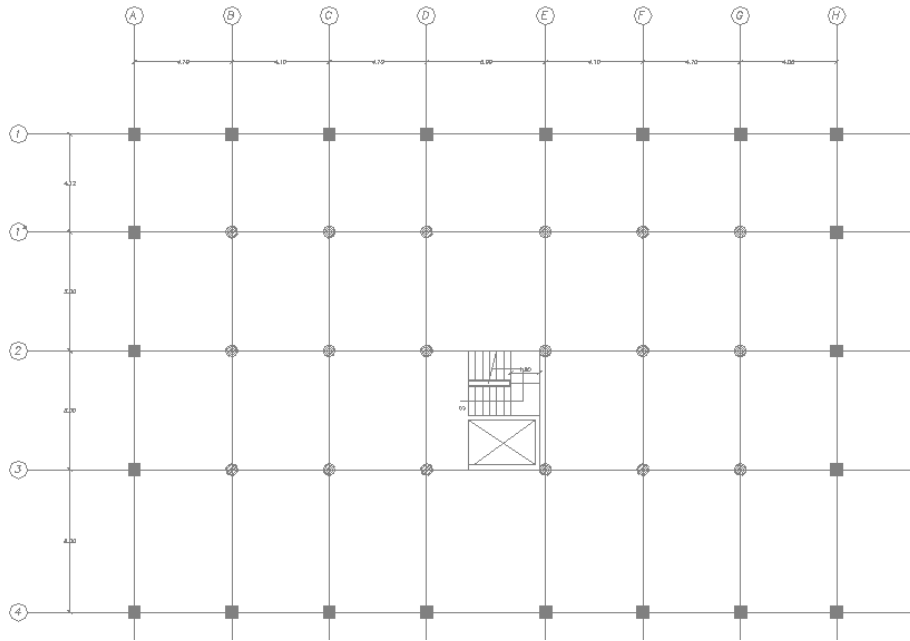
DISTRIBUCIÓN DE COLUMNAS EN PLANTA TIPO
